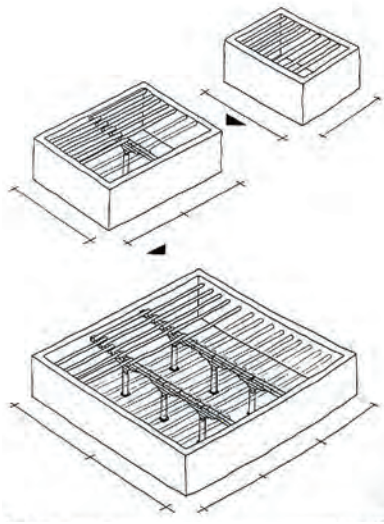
Konstruktives Grundelement tibetischer Architektur. Die kleinste Einheit bildet eine umlaufende Mauer mit einer Holzbalkendecke. (Meyer/Jest 1987: S. 138.)
